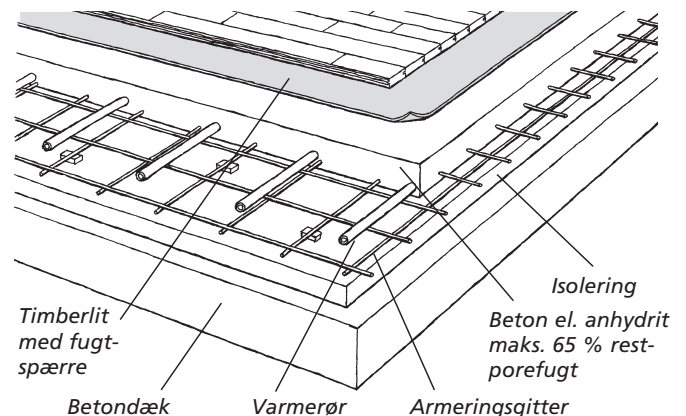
Betondæk med varmerør indstøbt i min. 70 mm beton som underlag for svømmende gulv. Som trinlydsdæmpende lag anvendes Timberlit med indbygget fugtspærre. Foliesiden vendes opad for at beskytte den mod perforering.
